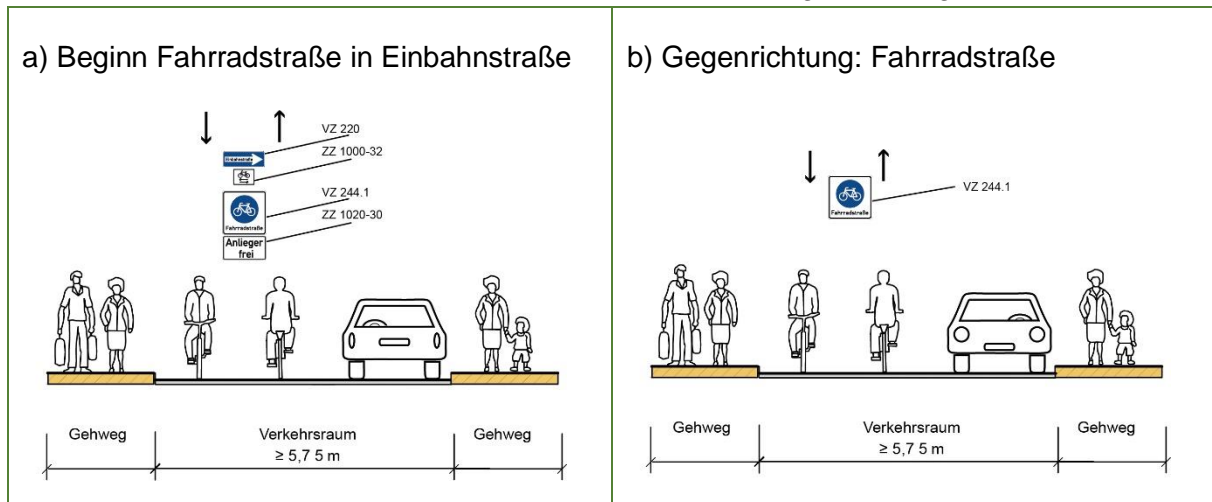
Pendler-Radroute auf Fahrradstraße in Einbahnstraße
